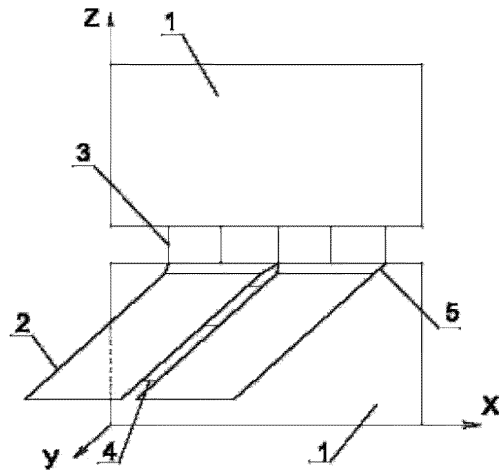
Расстановка связей между перекрытиями и стеновыми панелями:
